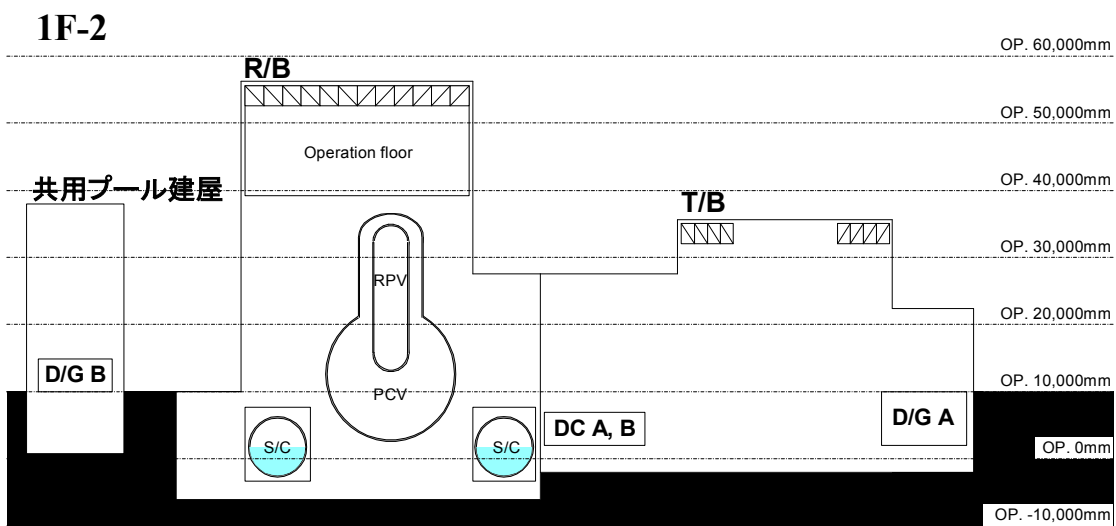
福島第一原子力発電所 2号機 建屋断面図
